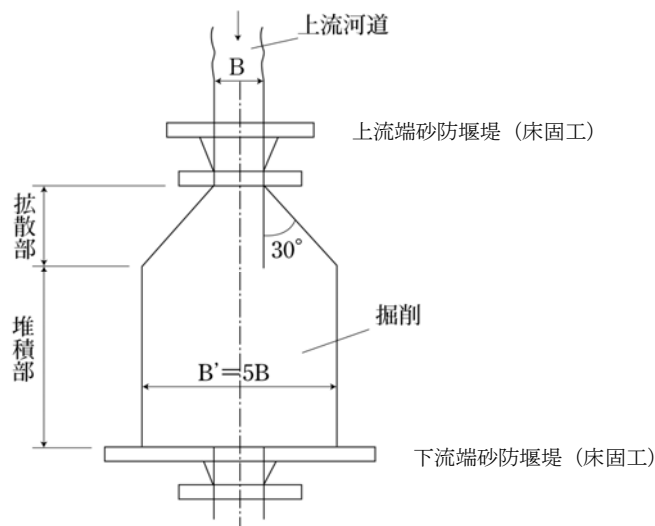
沈砂地の平面形状（将棋駒形の例）
